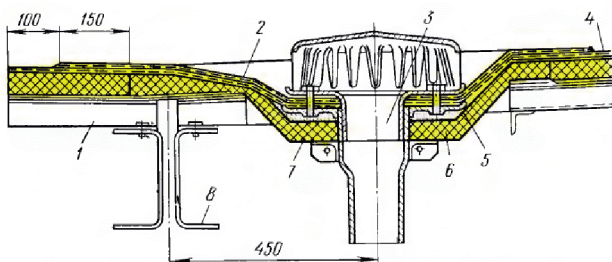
Устройство рулонной кровли на облегченном покрытии в месте пропуска водоприемной воронки:
